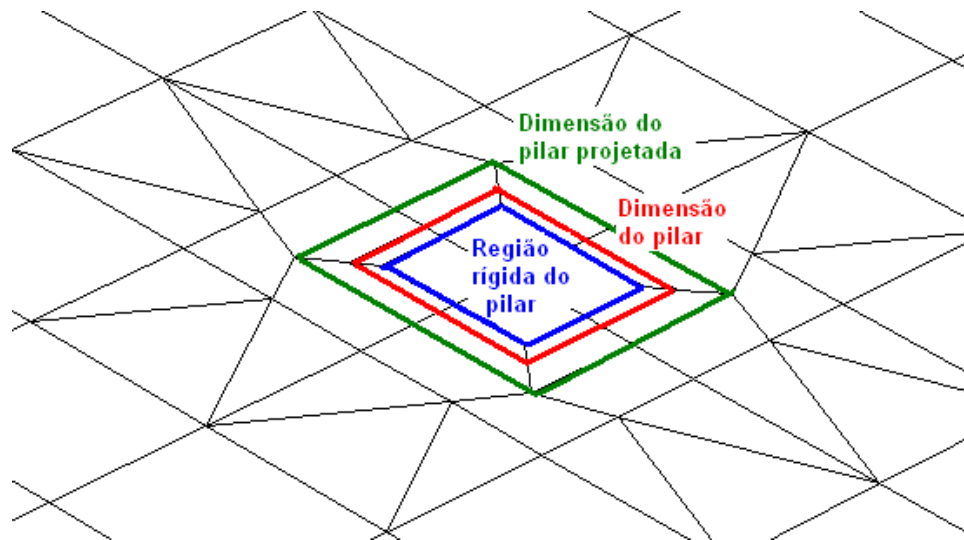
Região do pilar mostrando o trecho rígido, a dimensão do elemento e a dimensão projetada no centro de gravidade da laje – MEF
